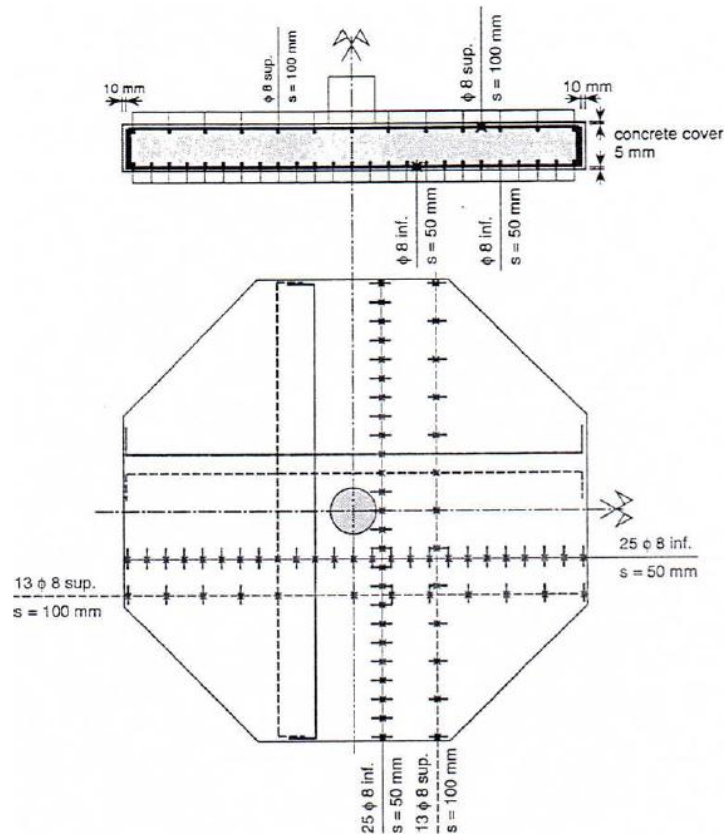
Armadura Inferior e superior utilizada nos modelos [30]
